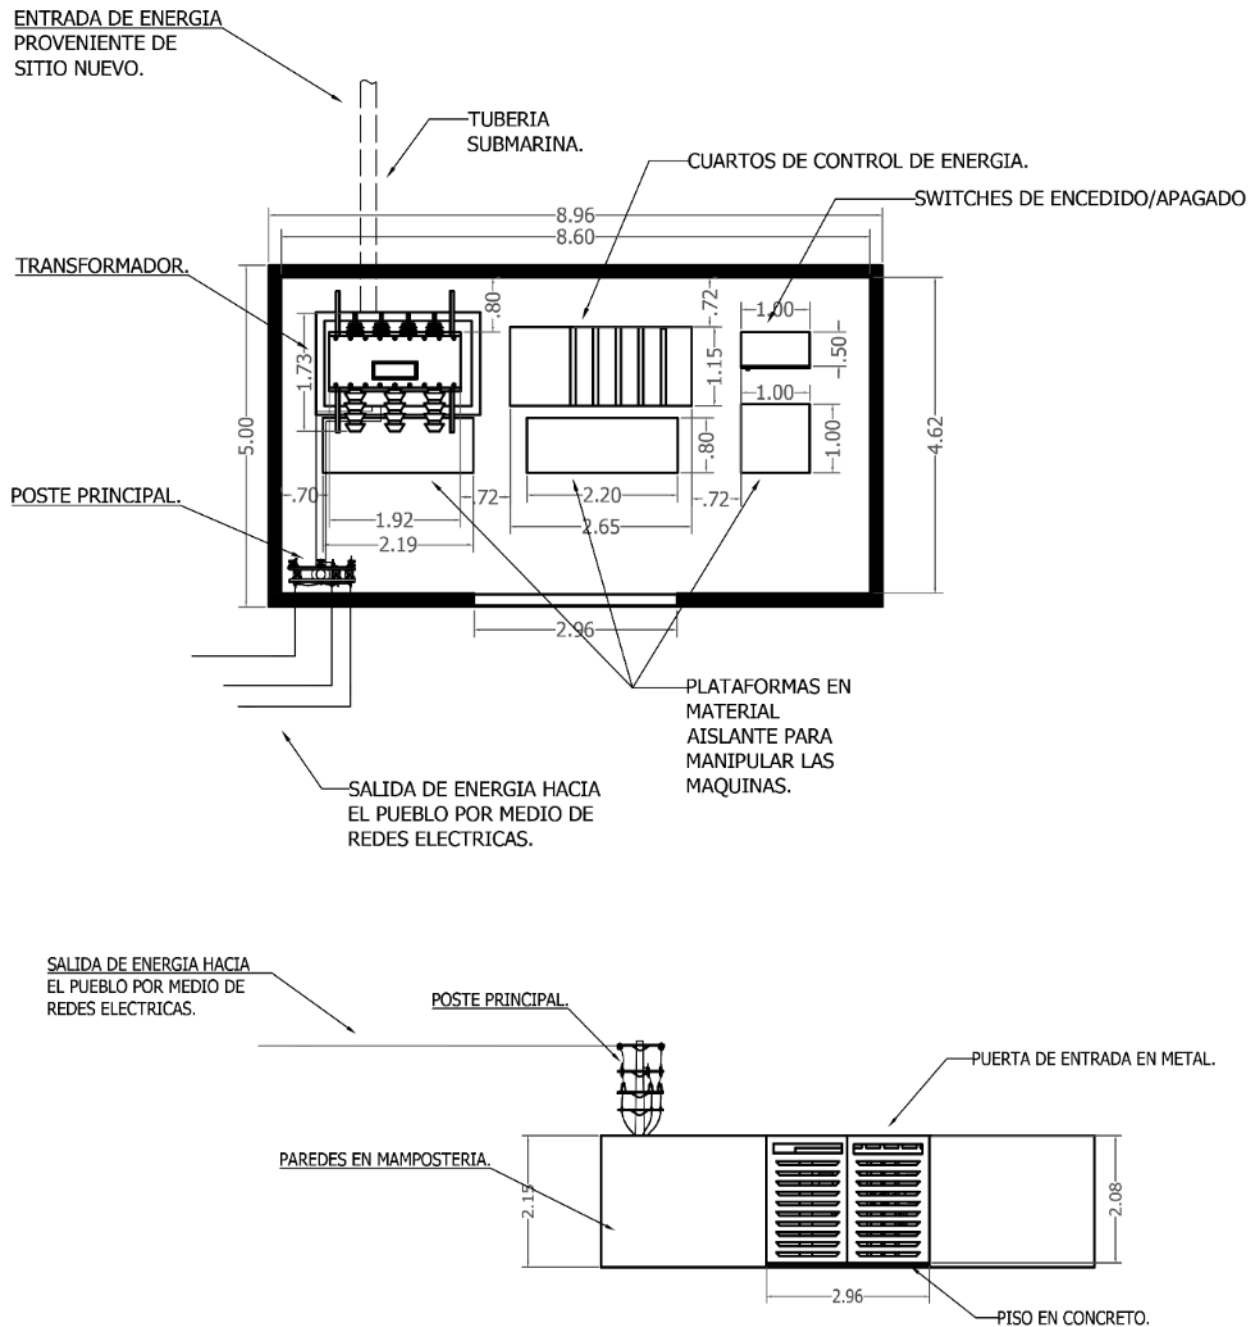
Planta y alzado subestación eléctrica Fuente: Elaboración propia.
